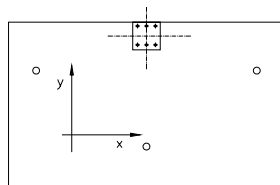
Detalhamento das armaduras passivas dos modelos.
